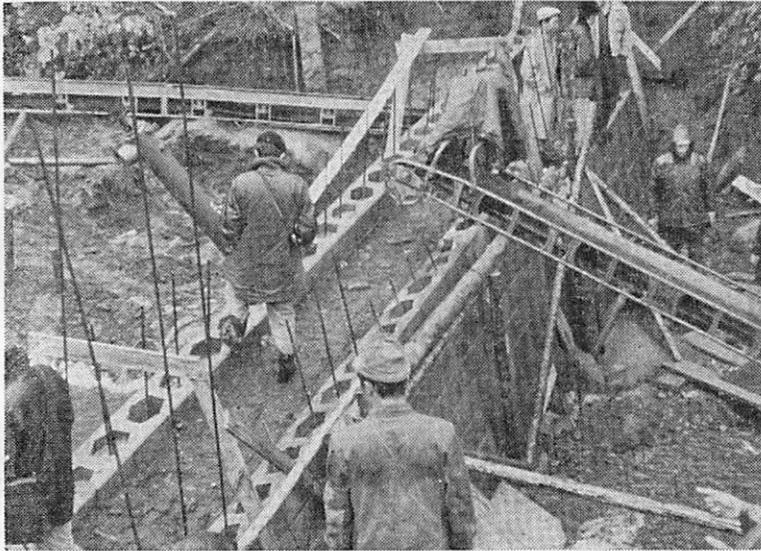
コンクリートブロック工法（H型ブロック積環堤）
